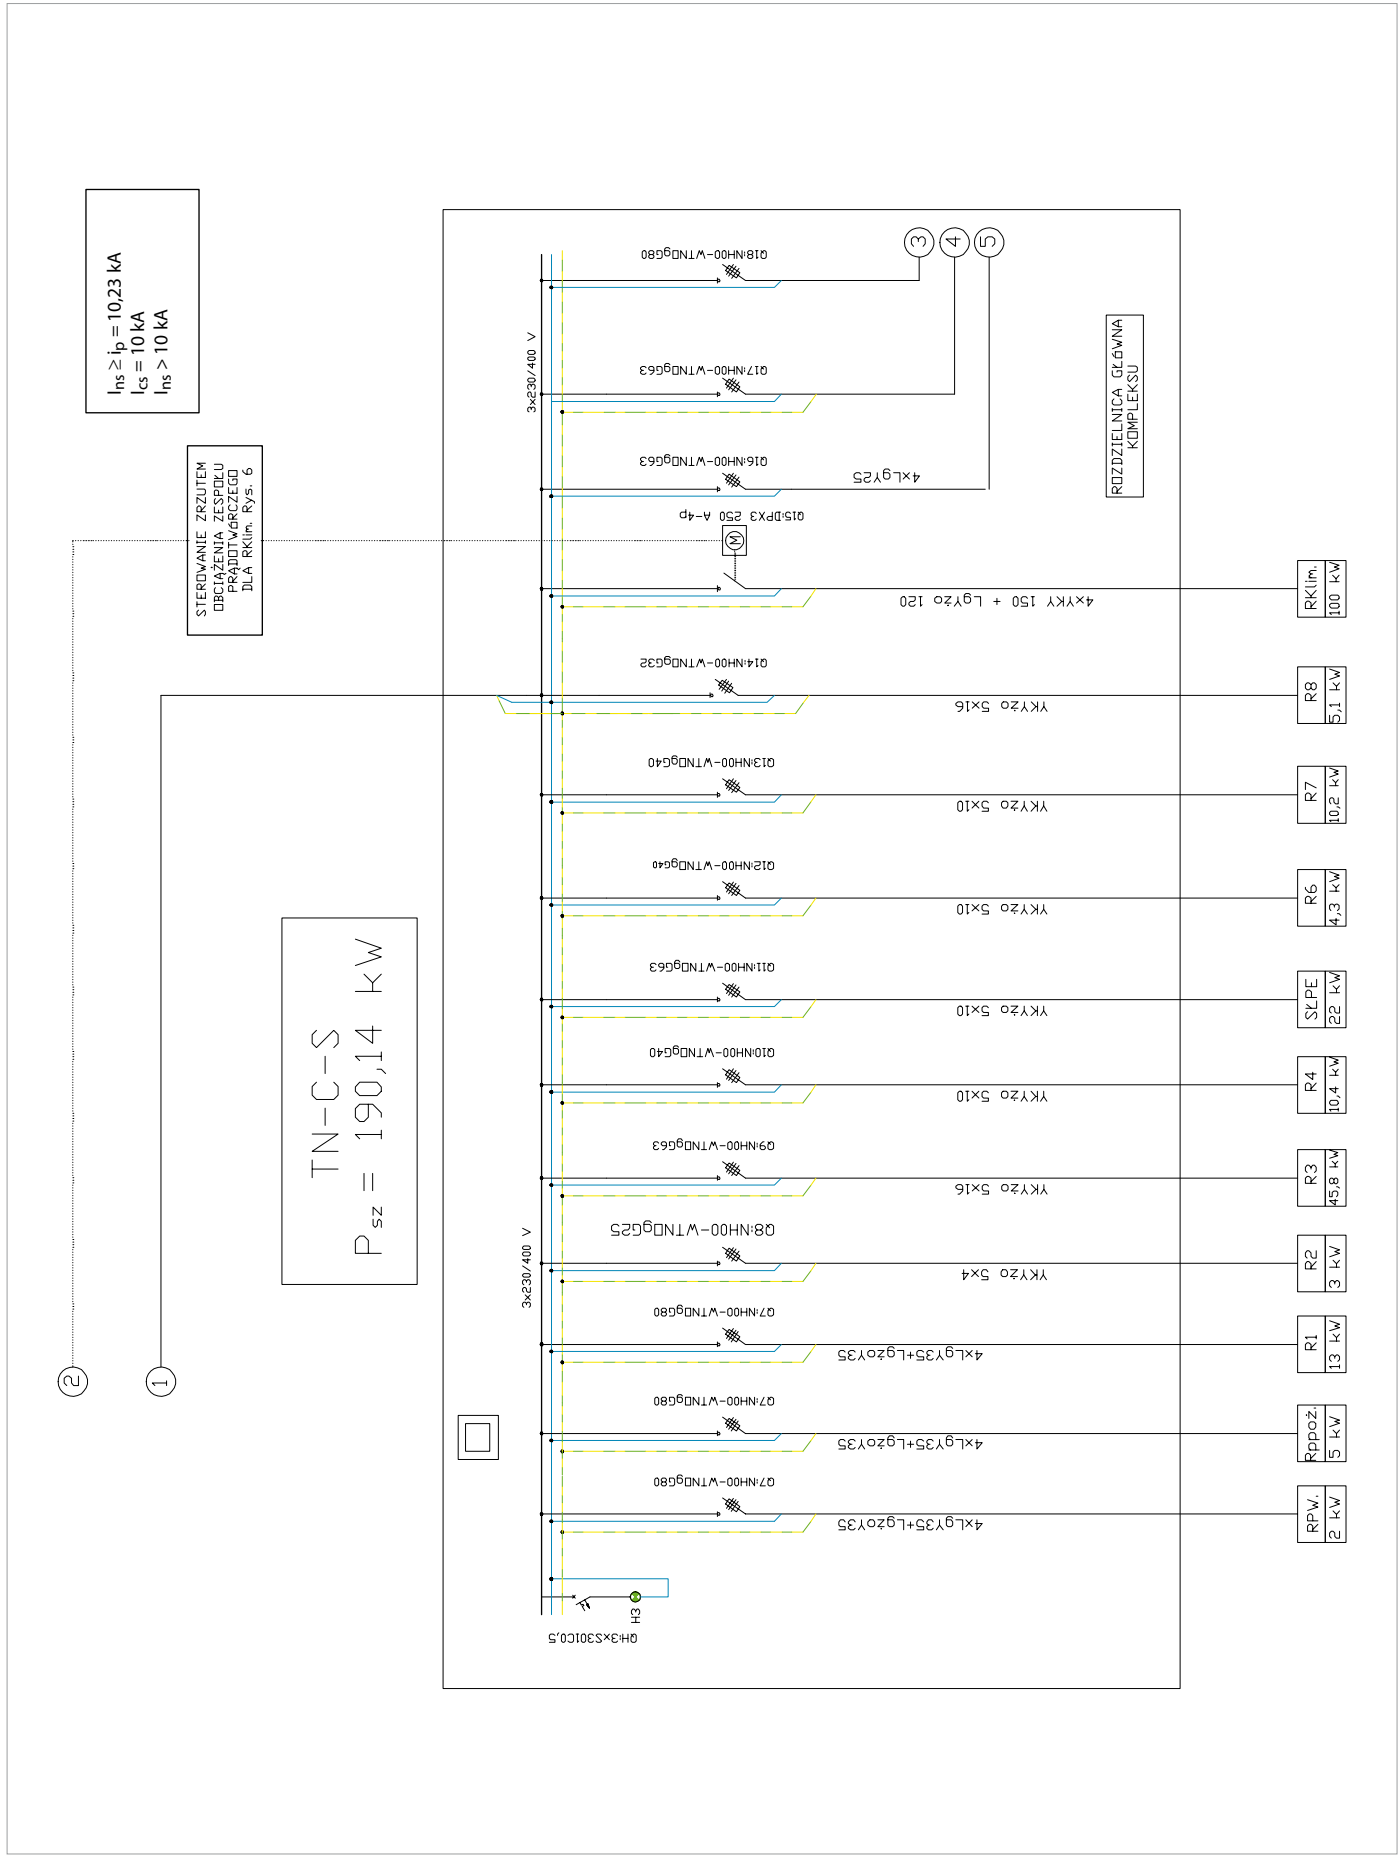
Plan instalacji RGK rys. J. Wiatr
